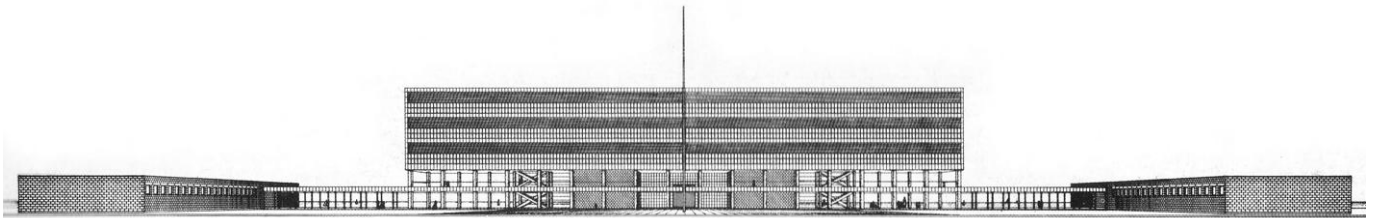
progetto finale, vista prospettica fronte strada, 1938, Archivio Vaccaro
